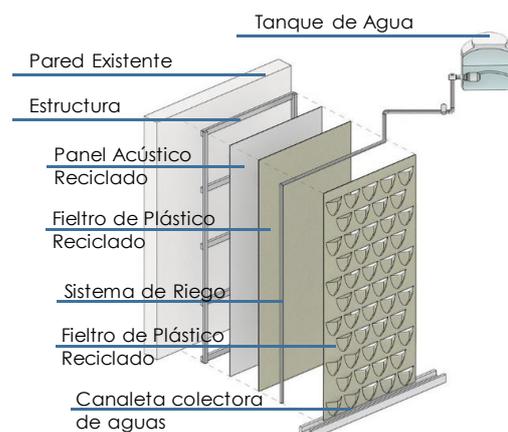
Muros verdes en la fachada del Centro Cultural
